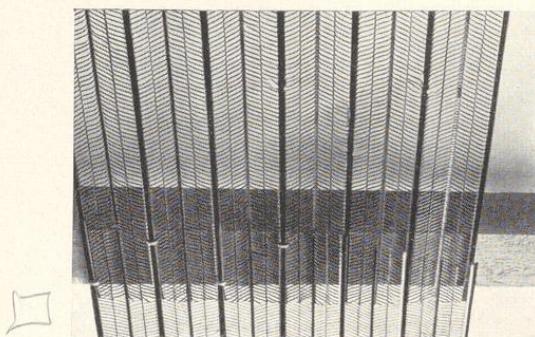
und 827. Befestigung des Rippenstreckmetalls an Holzbalken mit Nägeln und Krampen
